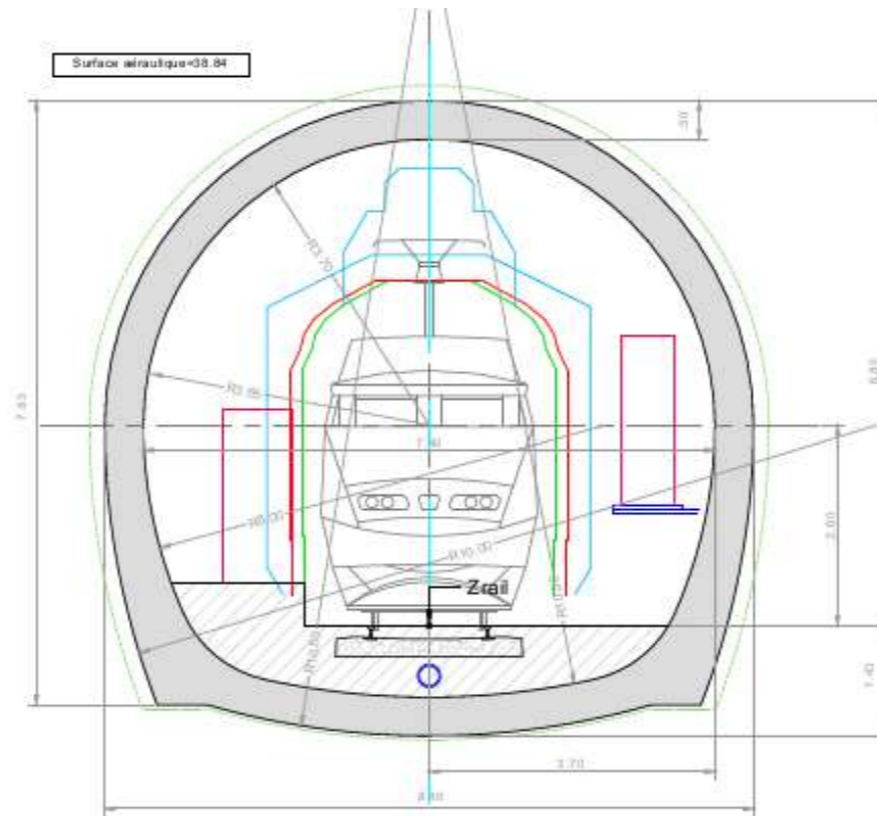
Profil en travers type du tunnel (EGIS, 2021)
